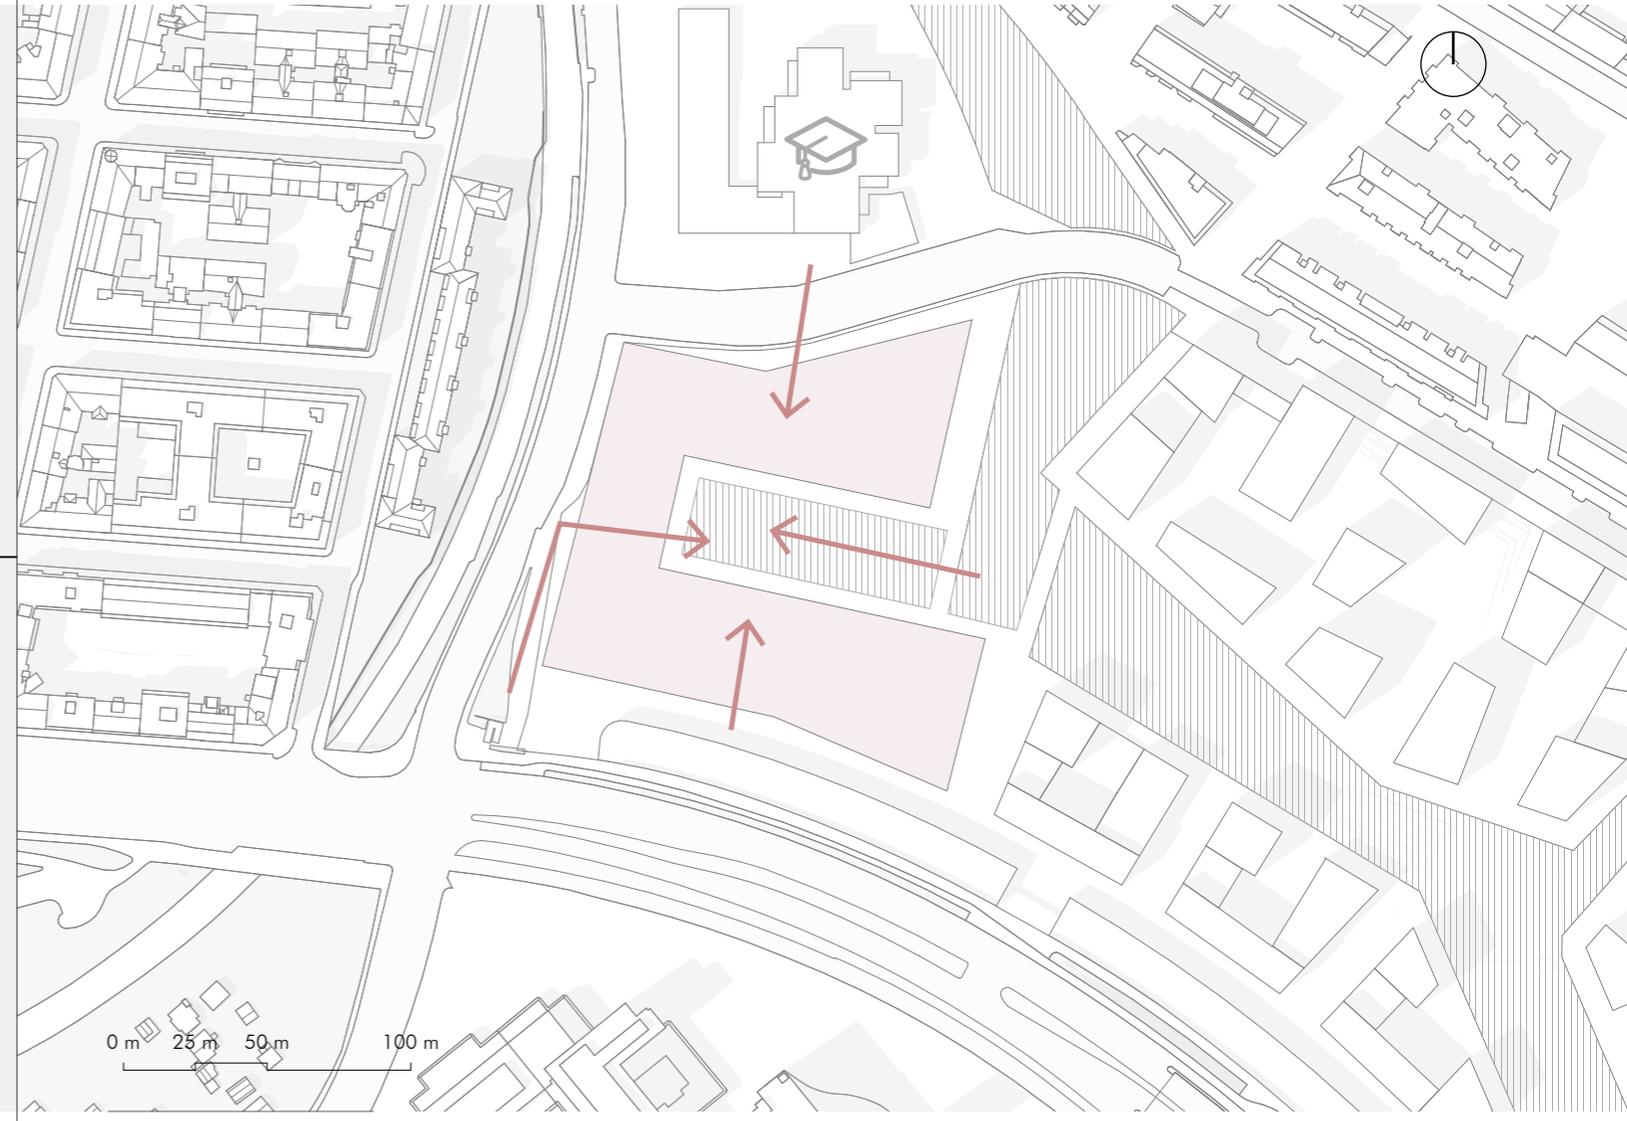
| Lageplan des Bauplatzes mit den Anfunftsachsen
